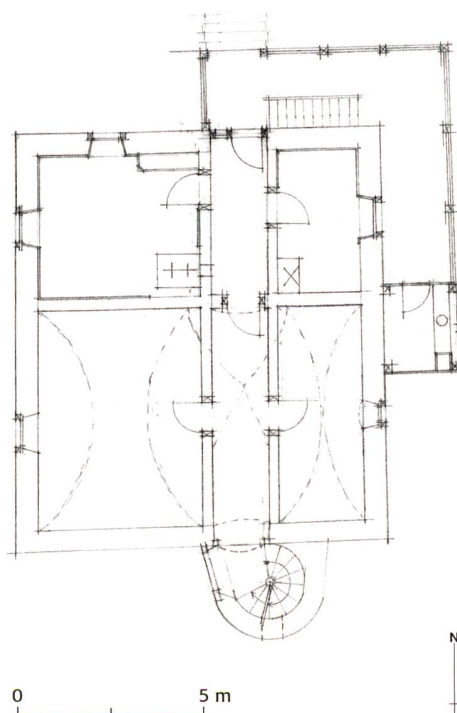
Trimmis, Haus Nr. 285 (Schlössli). Aufnahmeplan Grundriss Erdgeschoss. Mst. 1:200.
